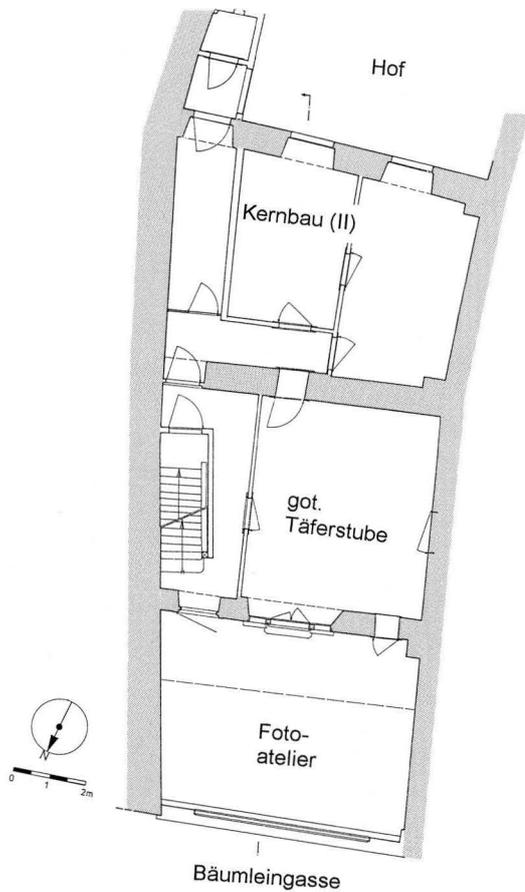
Bäumleingasse 14. Grundriss des 1. Obergeschosses. – Zeichnung: H. Ritzmann. – Masstab 1:200.
